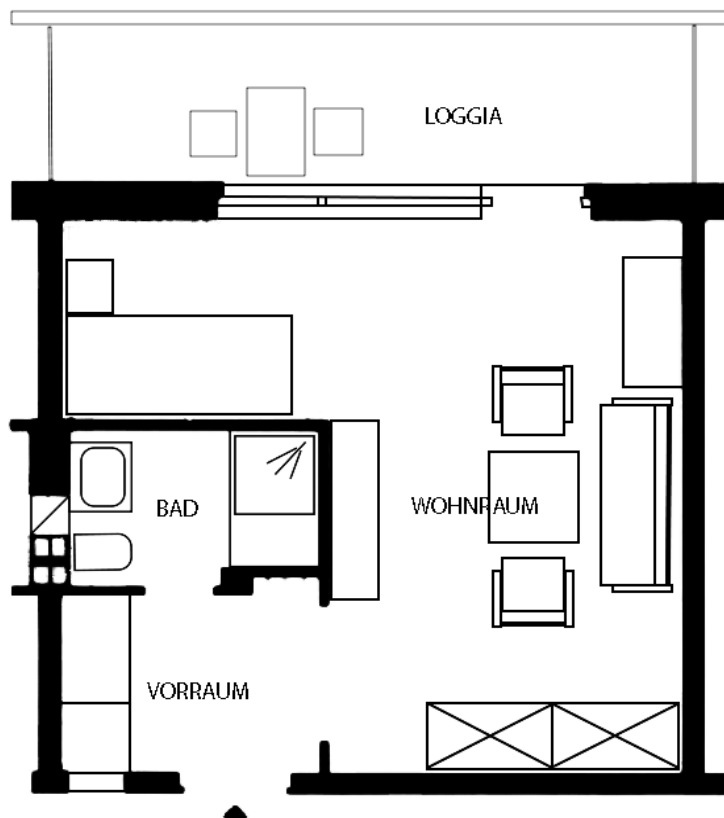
Ilse Vana-Schiffmann, Grundriss Einzelzimmer, Haus Liebhartstal, 1969, Wien.
